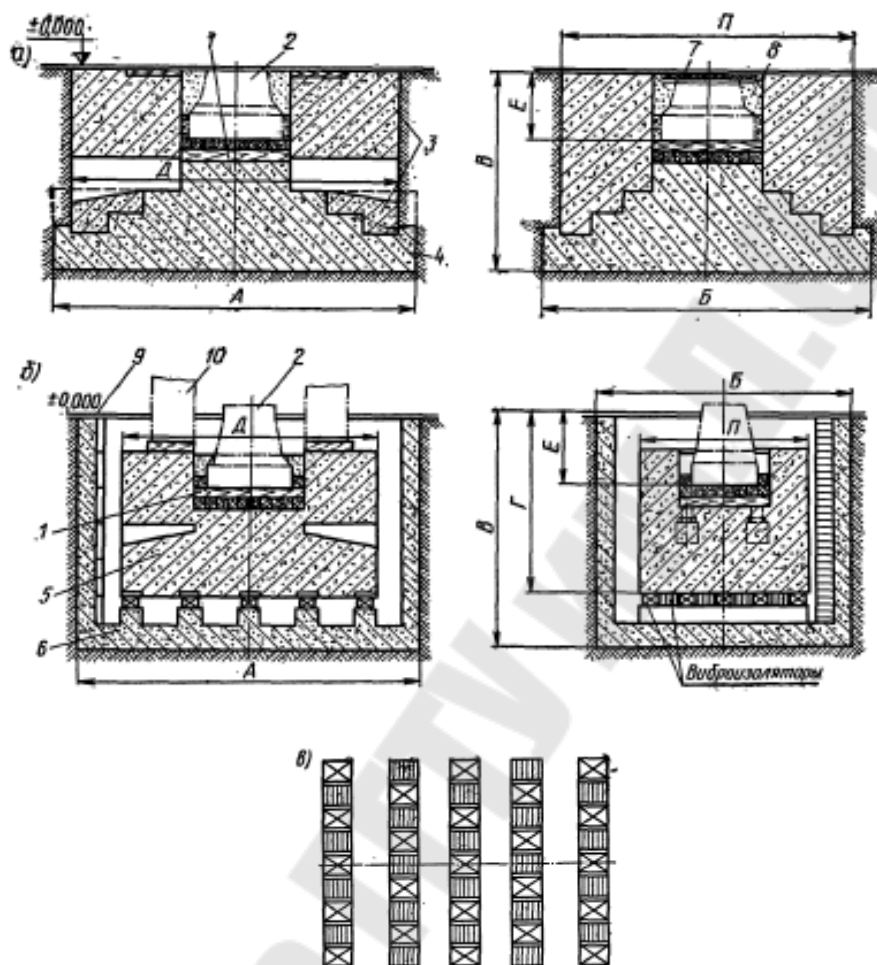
Схемы фундаментов под паровоздушные ковочные молоты :
